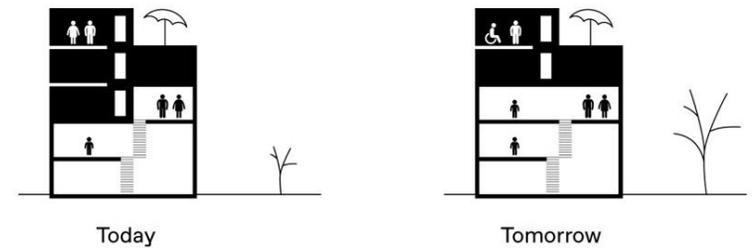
Esquema de proyecto. Elaborado por BETA office for architecture and the city
